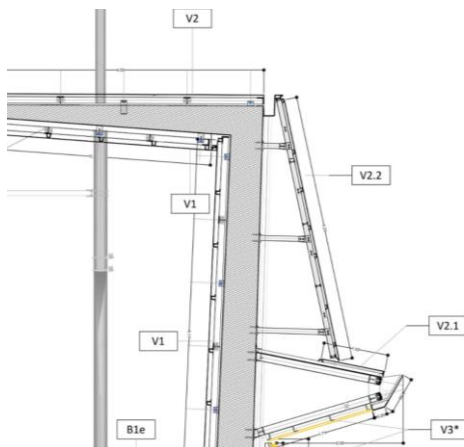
Sezione trasversale Muro zona parcheggio, rivestimento Tipo V2.2
